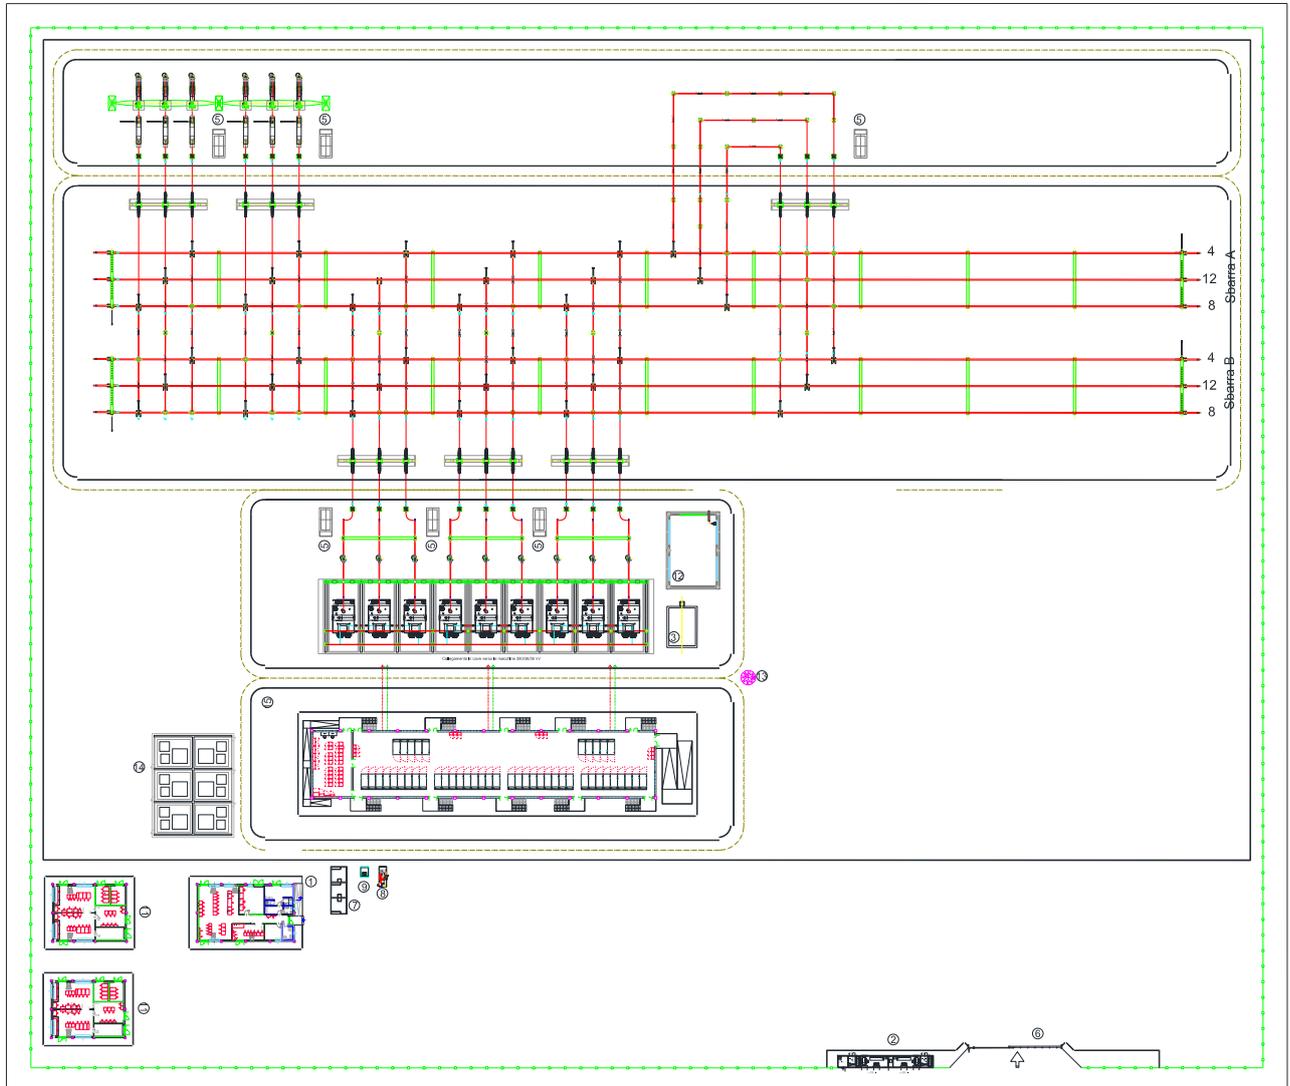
PLANIMETRIA ELETTROMECCANICA GENERALE
